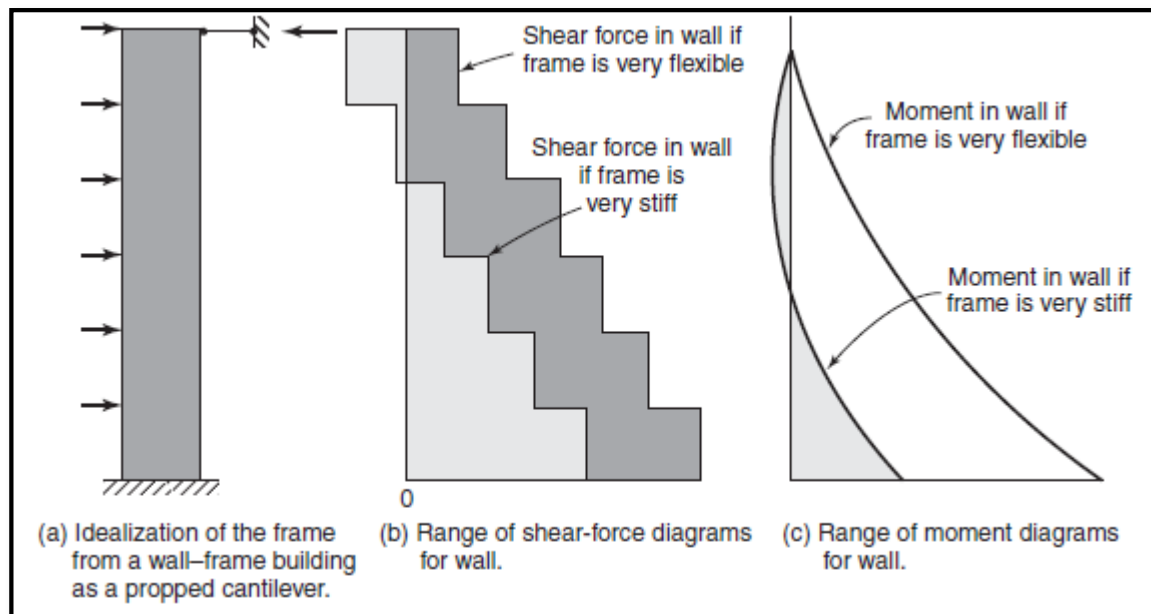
Efecto de rigidez del pórtico en iteración Muro - Pórtico
